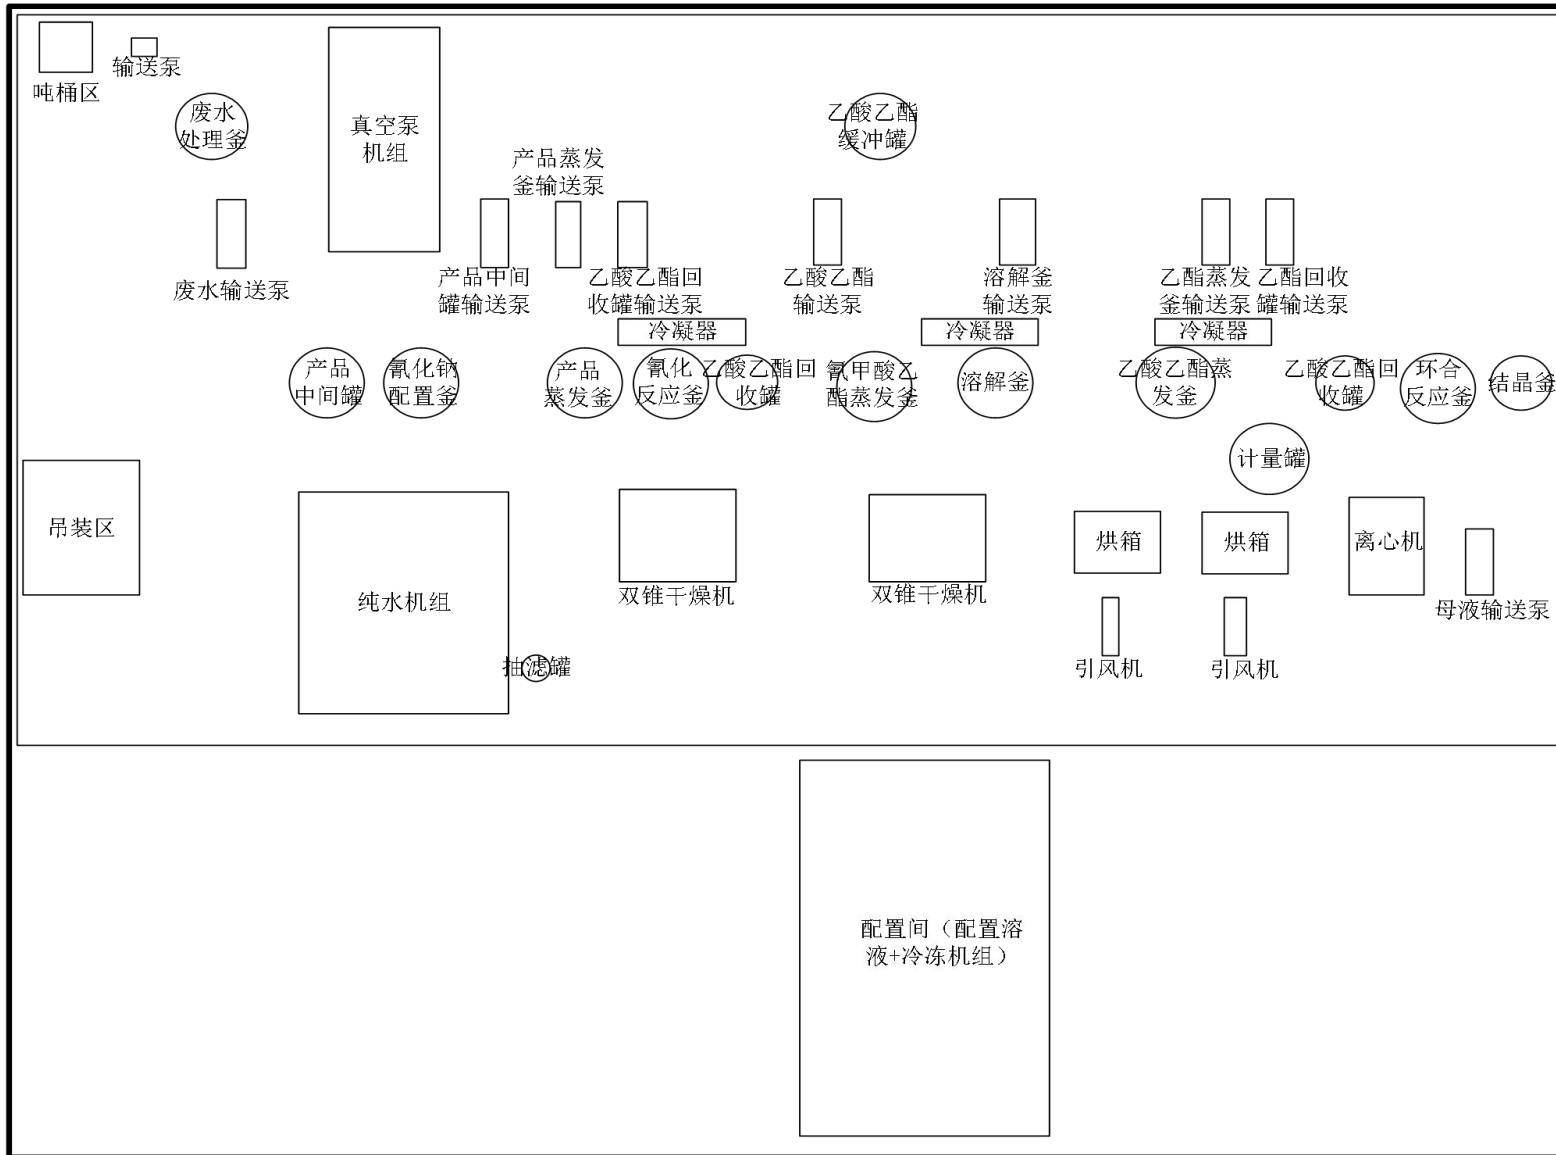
(c) 拟建项目 5-甲酸乙酯四氮唑装置区设备布置图
